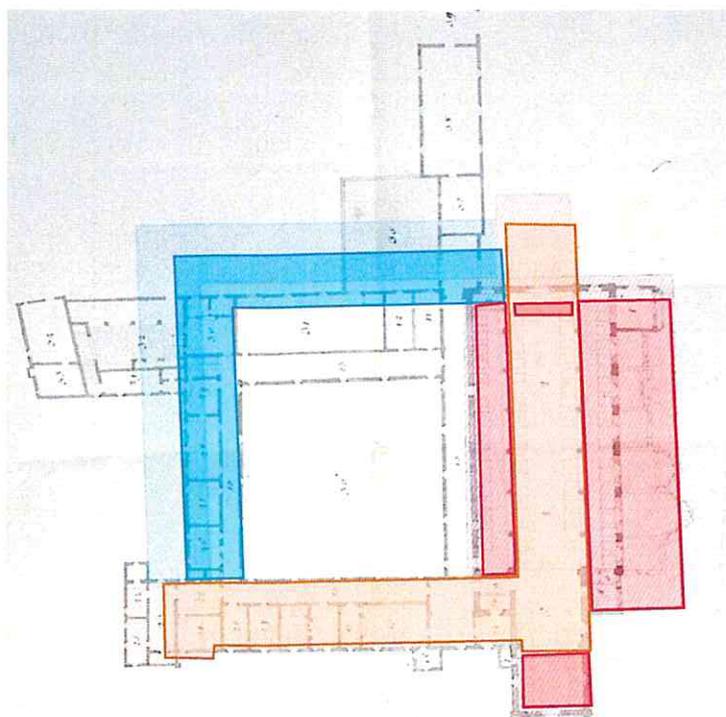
\_Evoluzione storica della planimetria del Palazzo degli Studi
